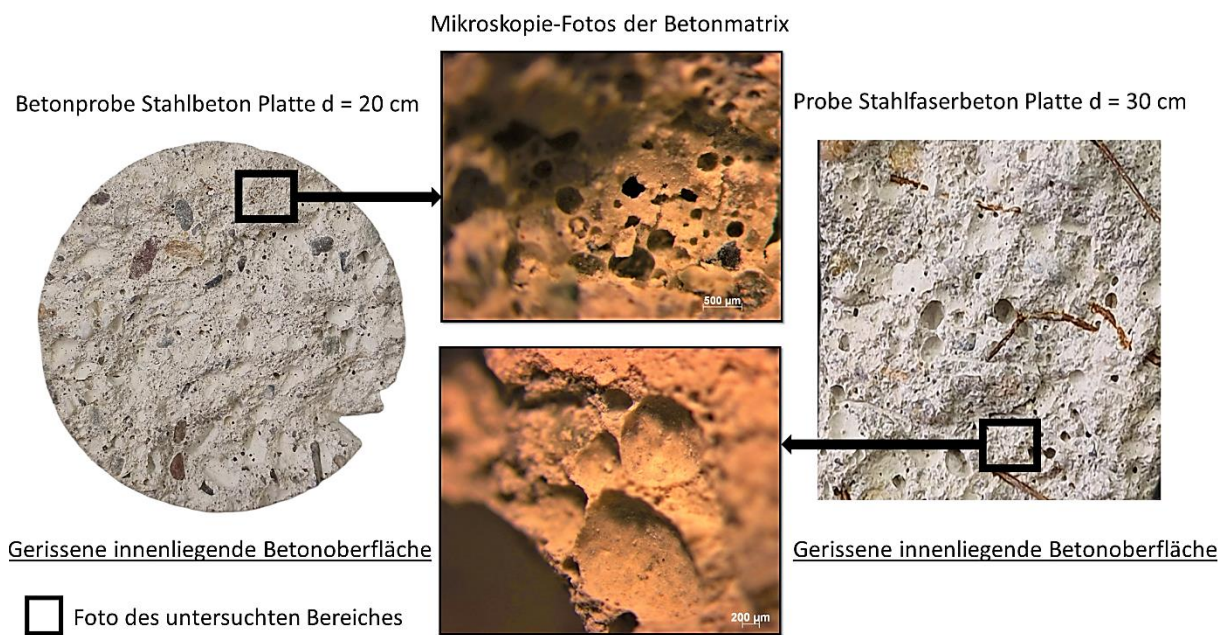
Mikroskopie der gerissenen Betonoberfläche von Stahlbeton- und Stahlfaserbetonplatte (entnommen aus Platte: S-20-0-3 und SF-30-1-1).
